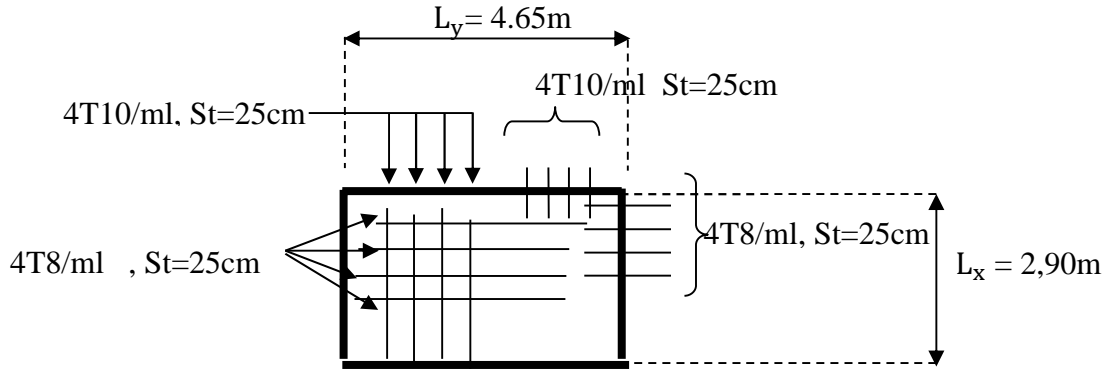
Schéma de ferrailage de la dalle sur 4 appuis
